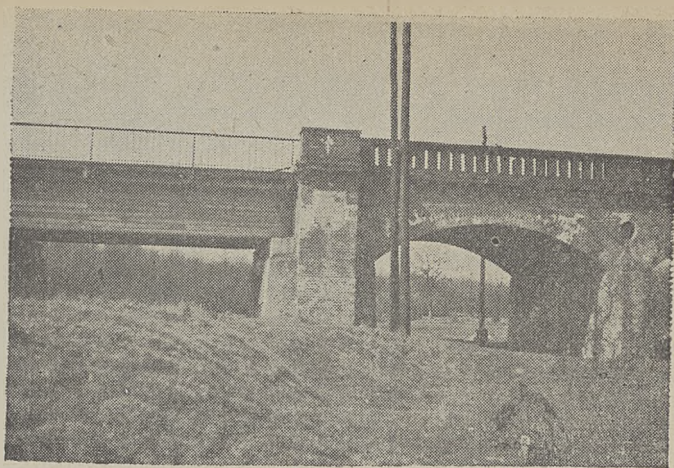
Przęsła żelazobetonowe na filarach kamiennych
